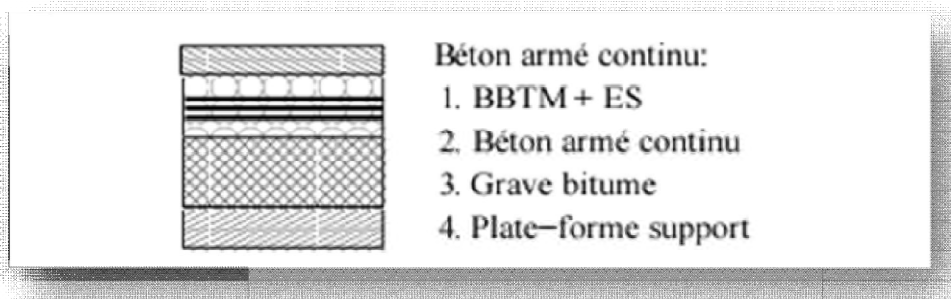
Béton armé continu sur grave bitume (BAC/GB) [1]
